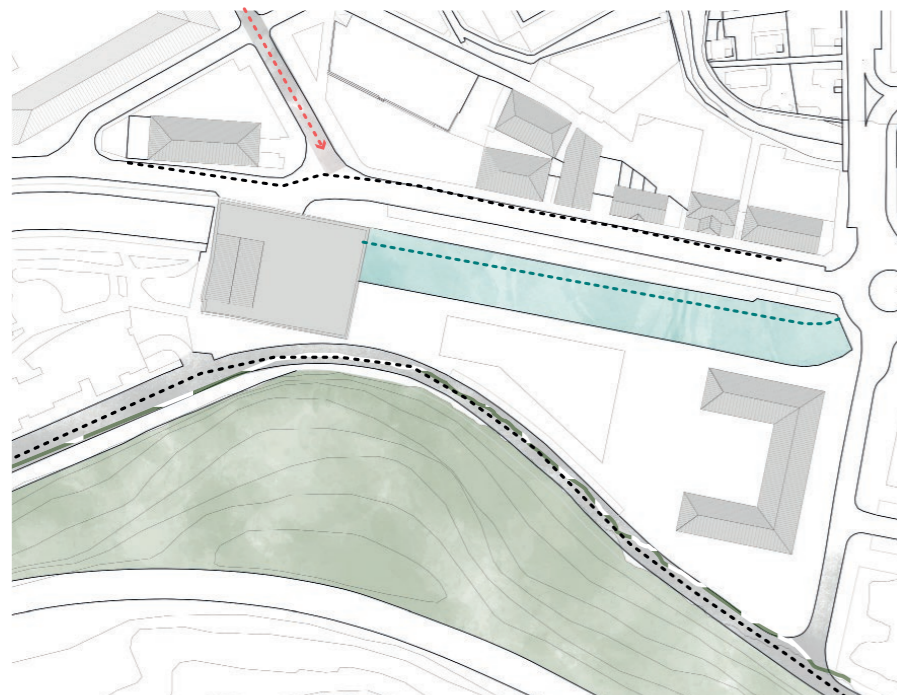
Plan urbanístico de Arrasate-mondragon de 2016
